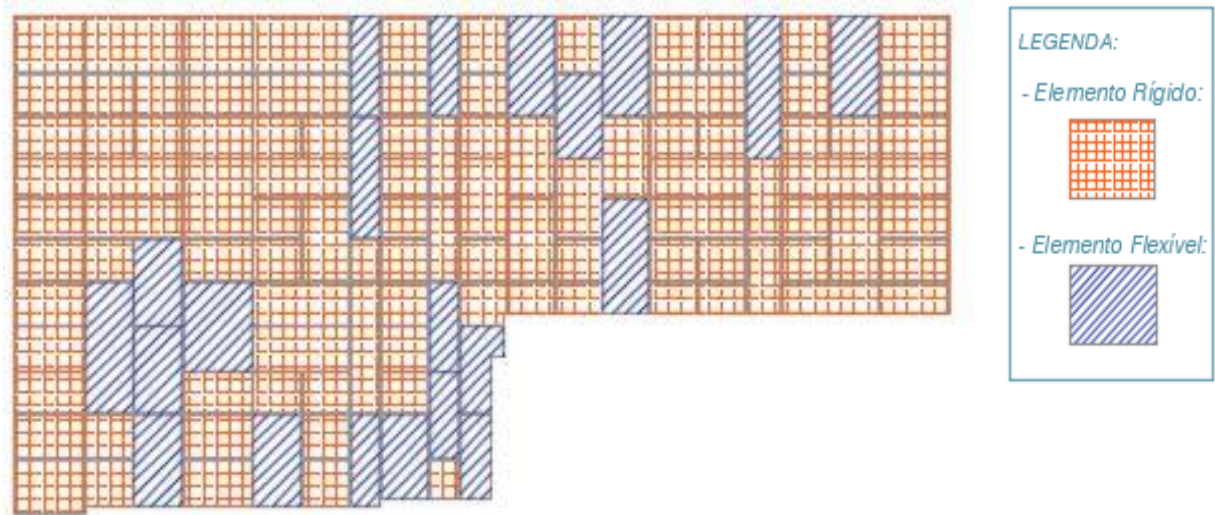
Elementos rígidos/flexíveis identificados na fachada
